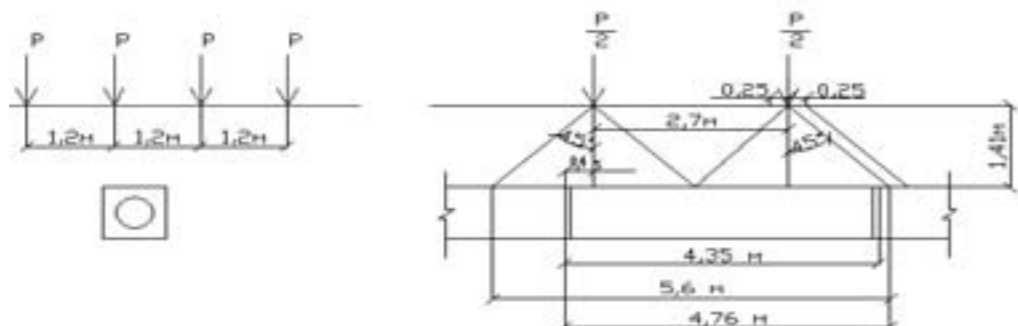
Схема навантаження від колісної дії тягача НК-80 на залізобетонну балку-обойму
